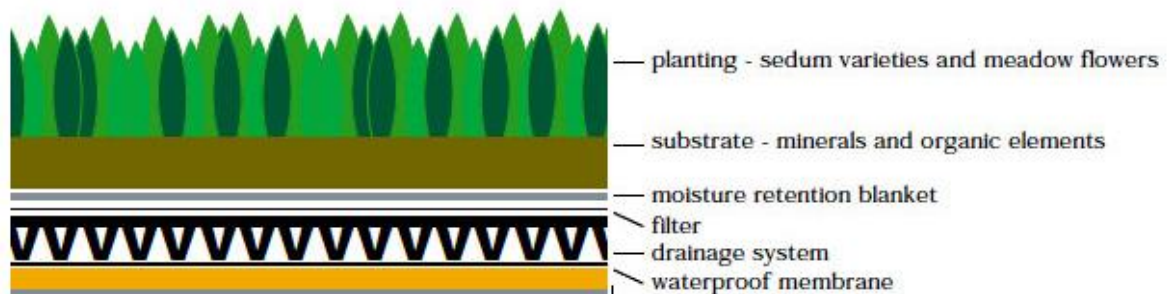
Modelo de cubierta verde dispuestos en cubiertas y terrazas (Roomworks 2011)
